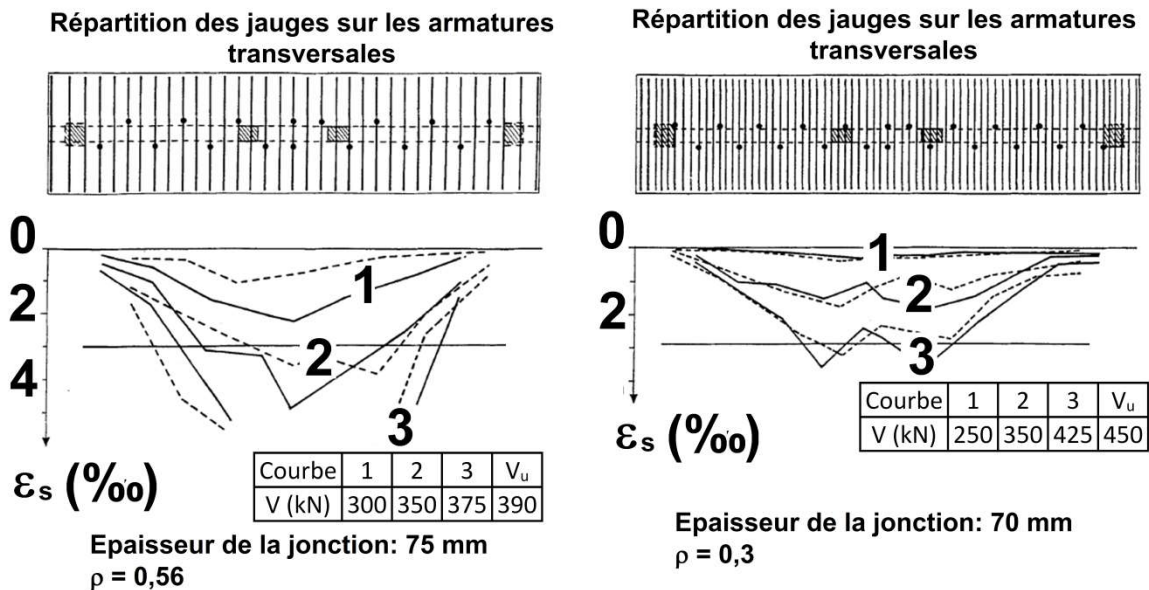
Déformation des armatures de couture (poutres non flechies transversalement)
